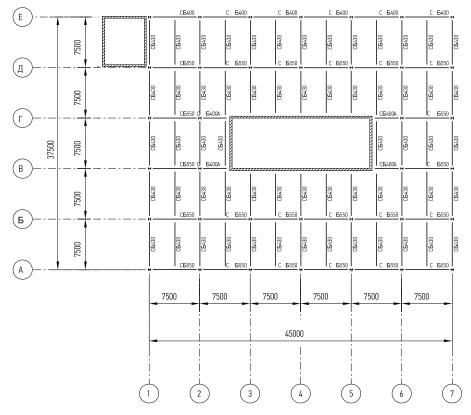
Маркировочный план несущих конструкций перекрытия типового этажа для короткопролетной схемы стального каркаса (уровни 3-18)
